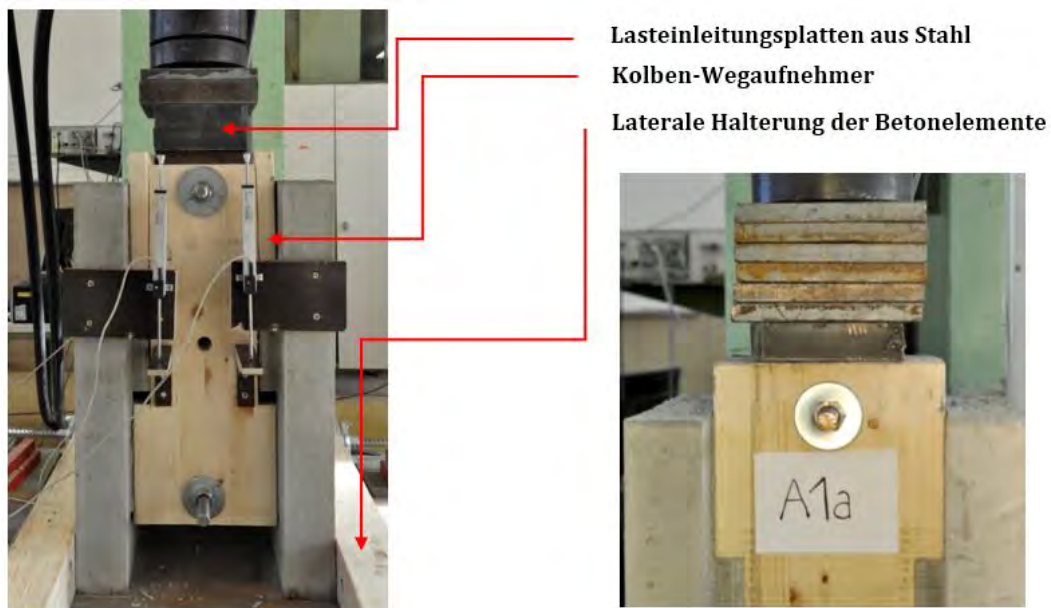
Versuchsaufbau für den Holz-Beton Probekörper, [4]
